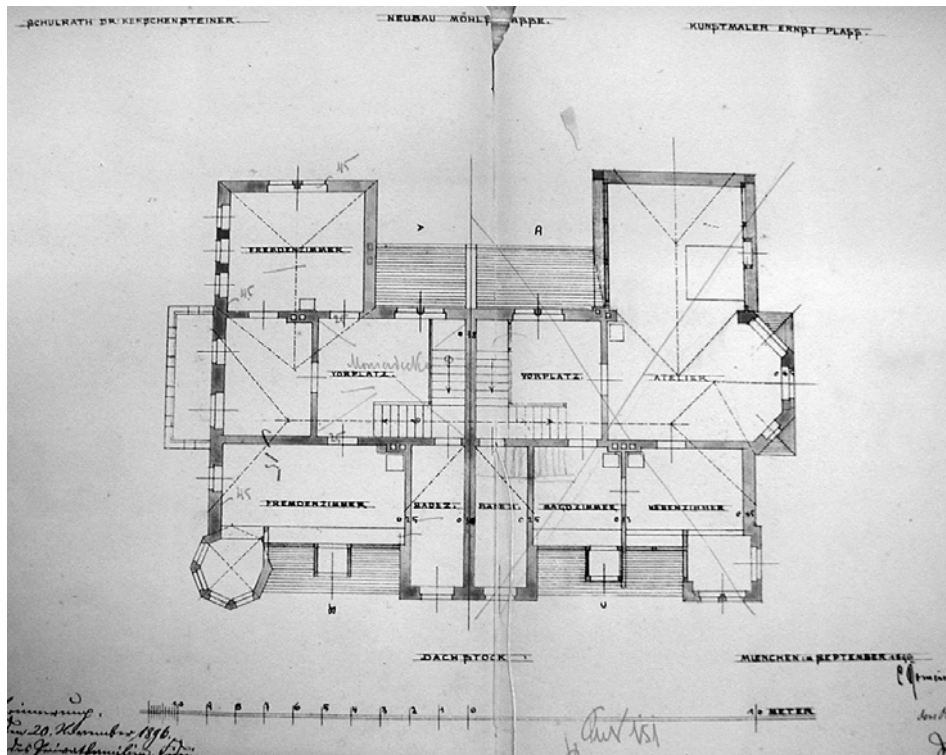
Doppelvilla Plaß/Kerschensteiner, Grundriß Dachstock (zweiter Stock), Leonhard Romeis, 1896, Plan nach Westen ausgerichtet.
